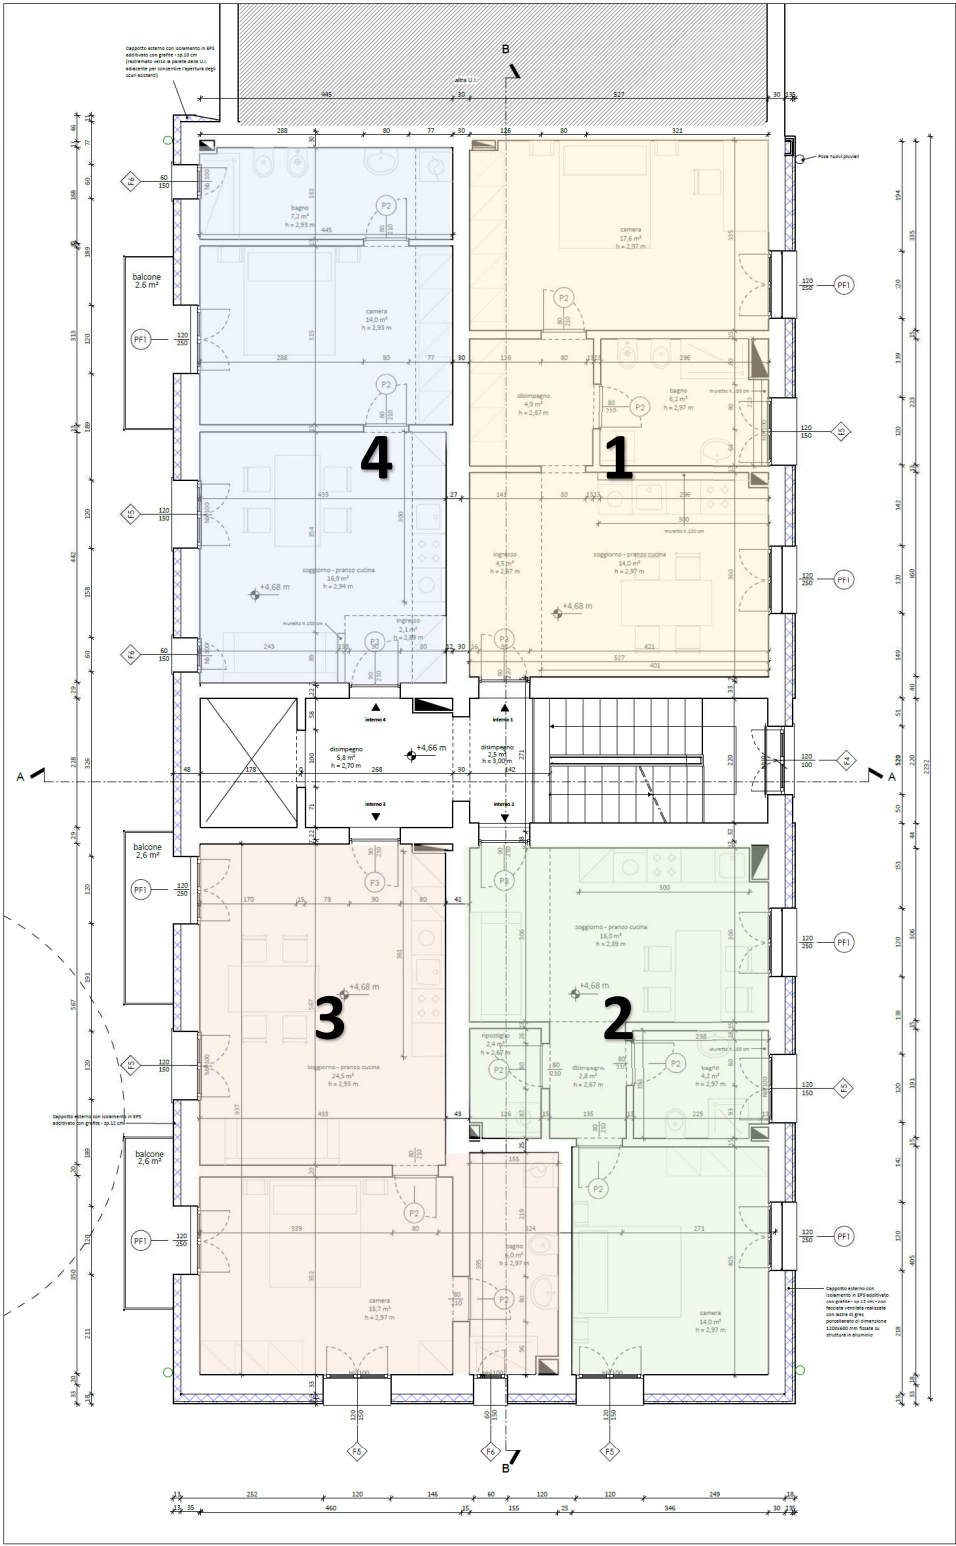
dal progetto architettonico: planimetrie dei piani dell'edificio – piano seminterrato, rialzato e primo
